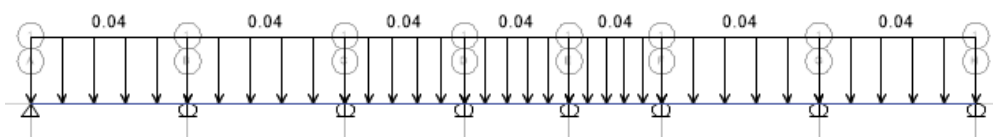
Carga viva distribuida en vigueta de losa aligerada
